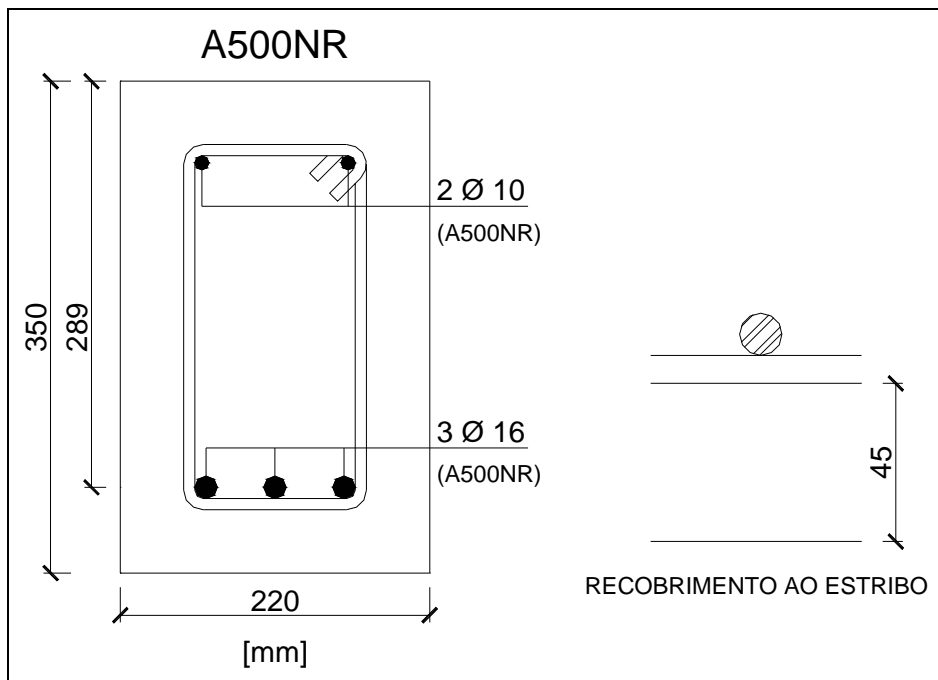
Detalhe da secção transversal das vigas de referência da 2.ª série.
